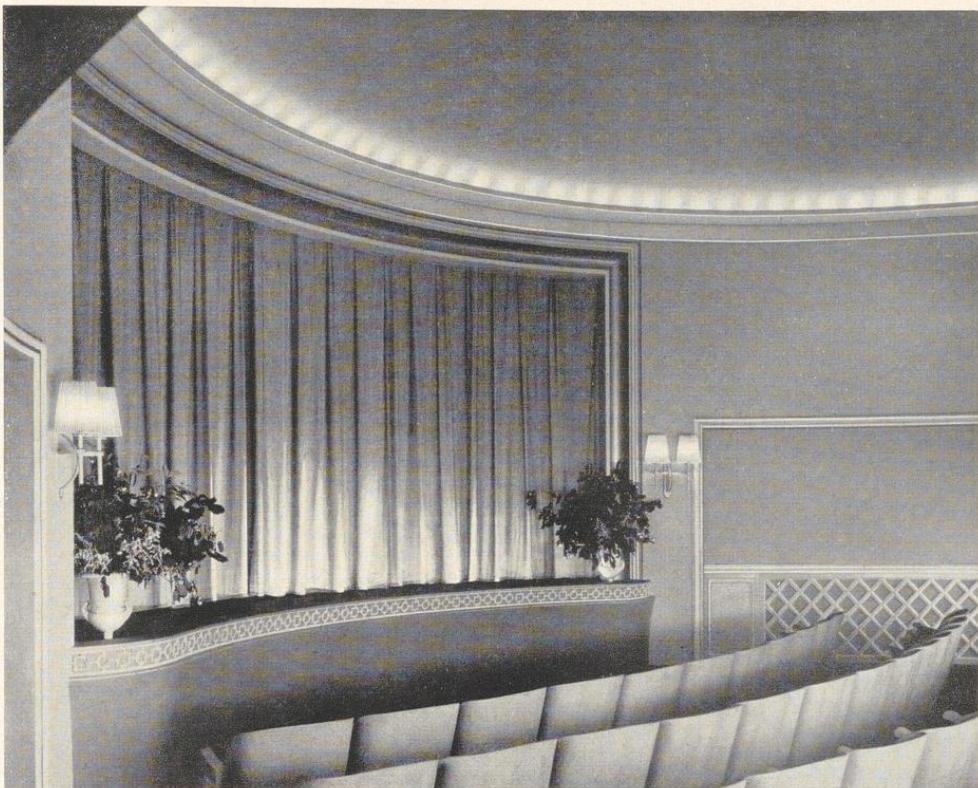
Atlantis-Lichtspiele in Bremen mit einer Flachkuppel in Rabitz, an Betondecke aufgehängt. Lichtpfanne unter der Decke, Bühnenumrahmung und Wandverzierung in Stuck gezogen. Entwurf Architekt Martin Zill, Bremen. Ausführung Lüning u. Sohn, Bremen
